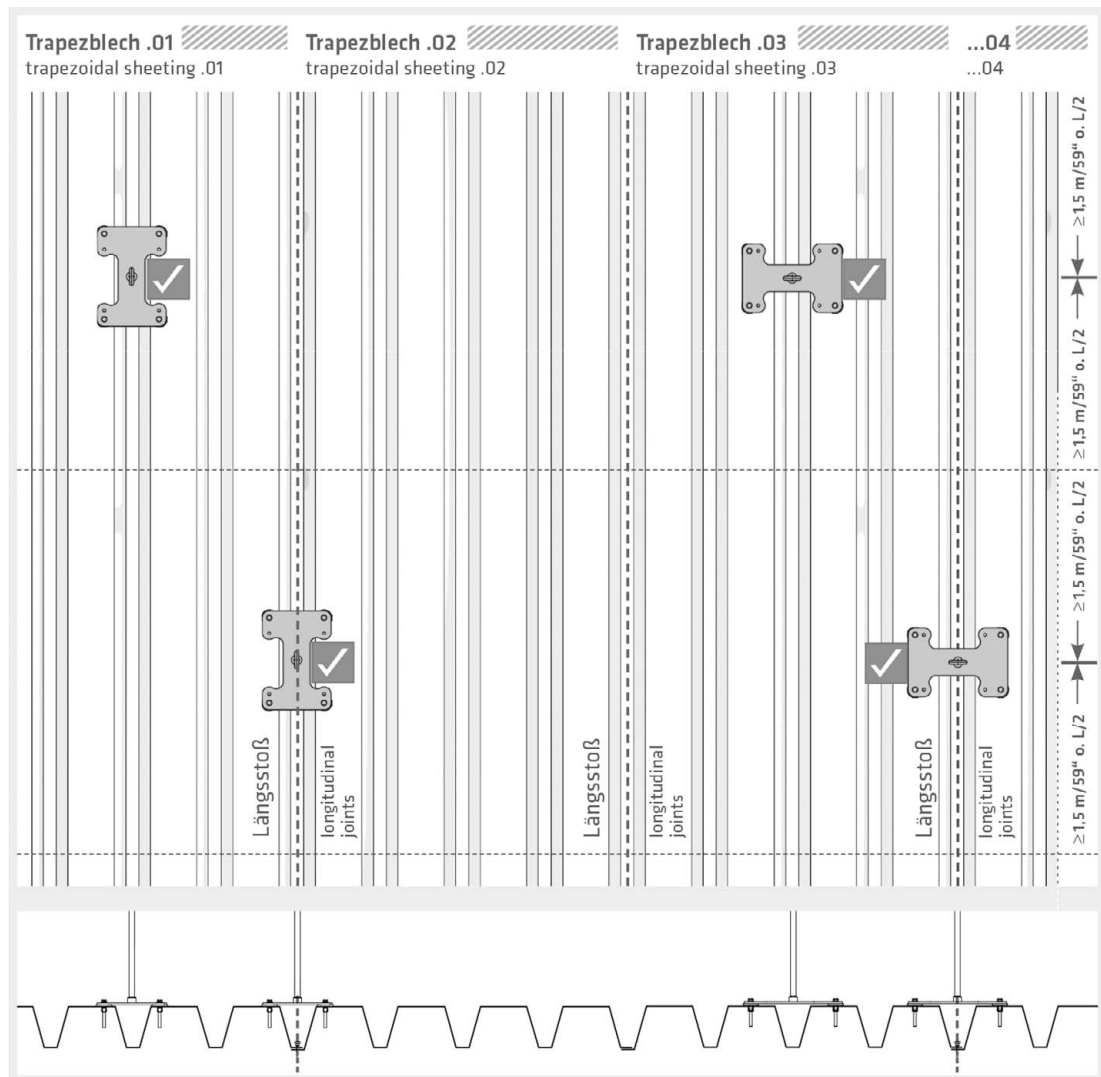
Montagevorgaben auf Trapezprofil bei Absturzrichtung in Trapezprofilspannrichtung
